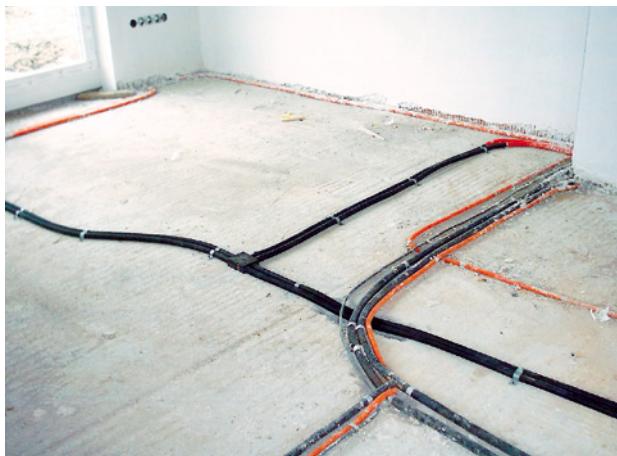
■ Fertiggestellte Abluftleitung im 2. Dachgeschoss
